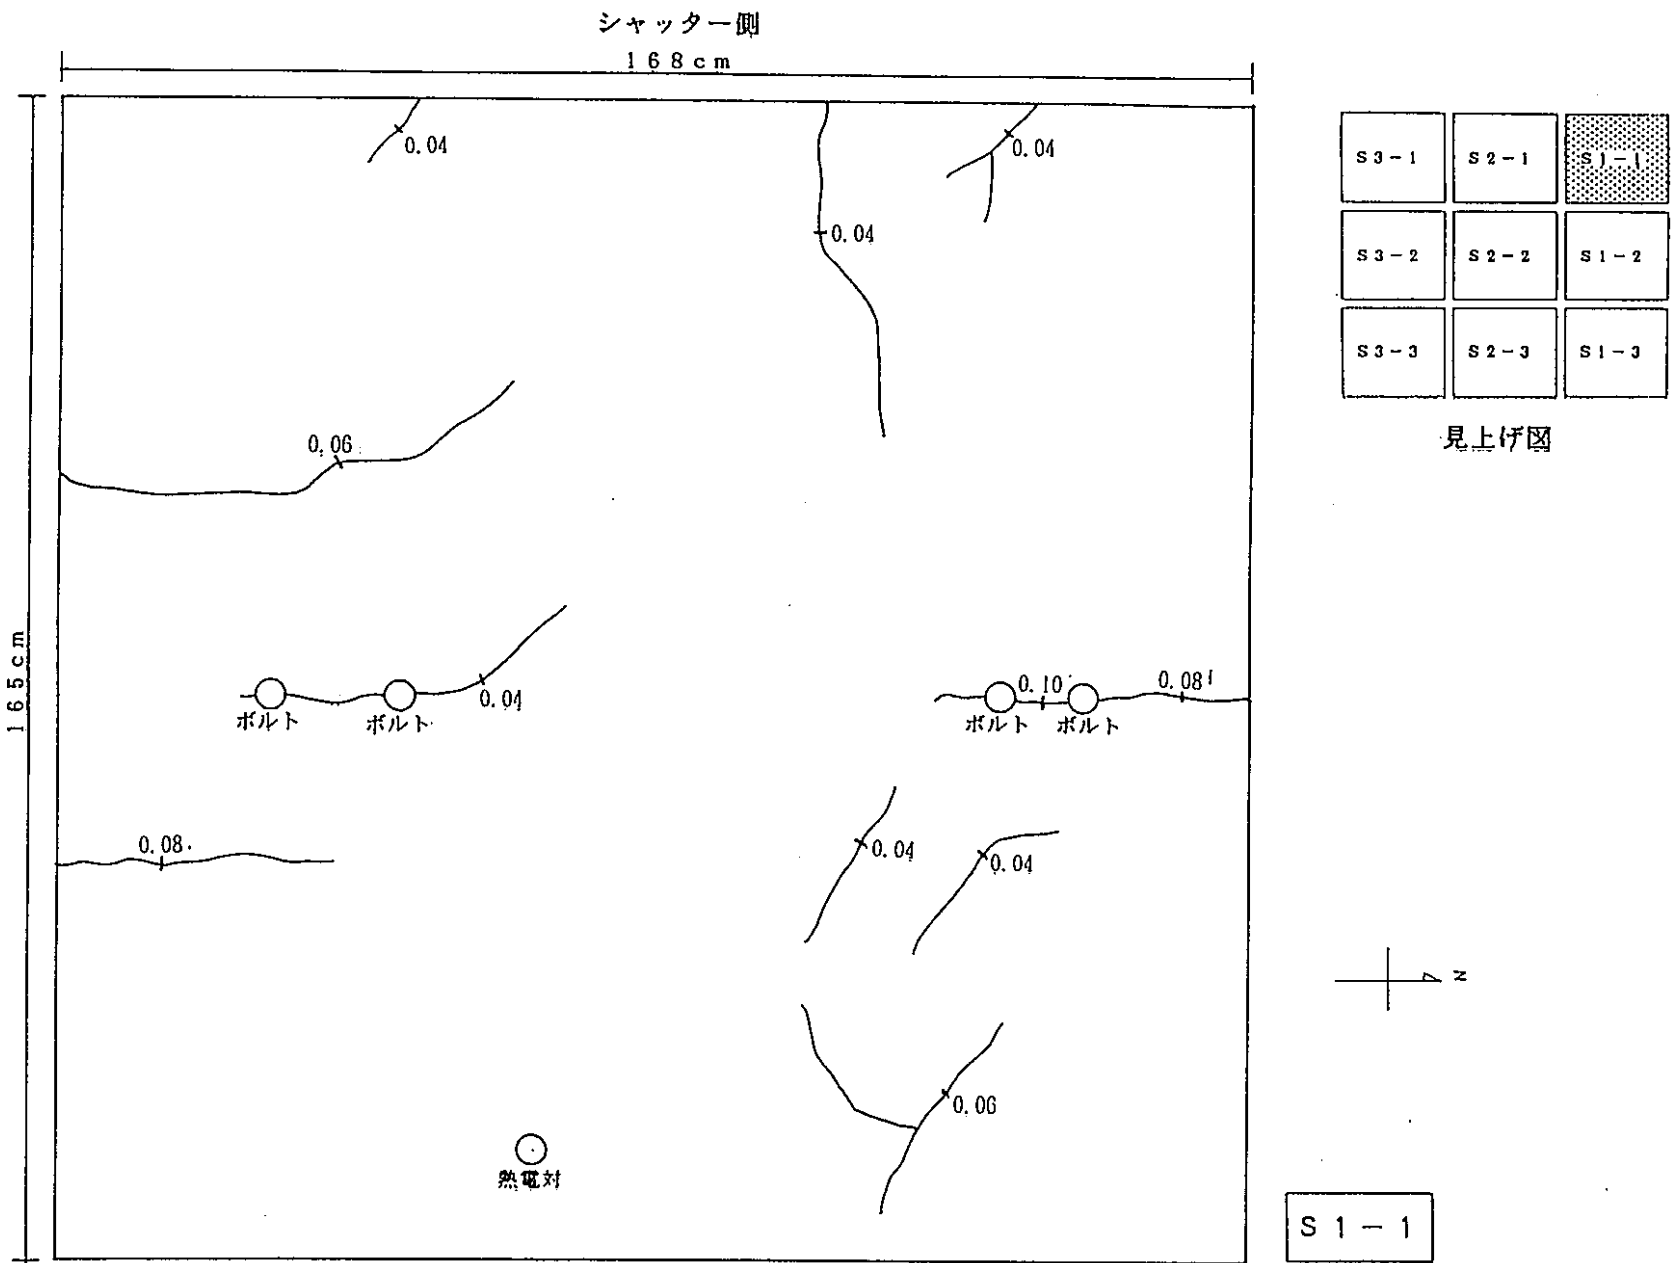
2 ひび割れ観察図 (S1-1)
